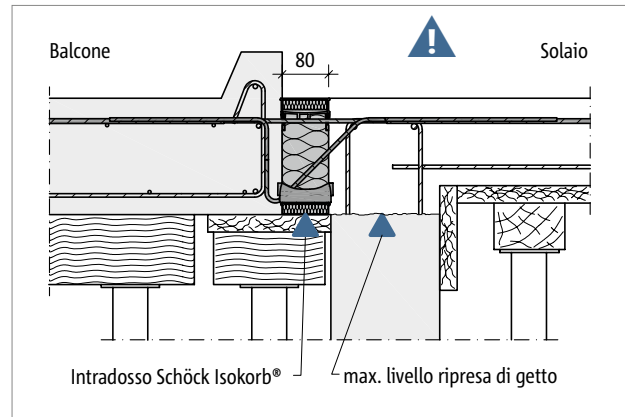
Schöck Isokorb® T tipo K: balcone prefabbricato dotato di solaio con dislivello su parete prefabbricata in calcestruzzo armato
